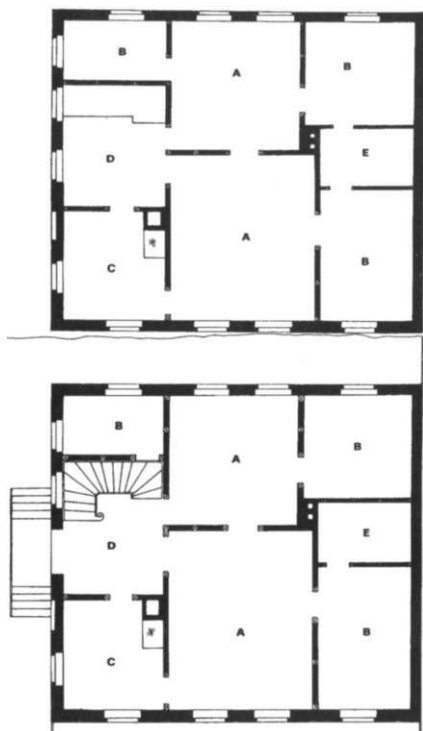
1858, Wohnhaus Olvenstedter Straße 48, Grundriß des Erdgeschosses und der Dachetage A Stube, B Kammer, C Küche, D Flur, E Alkoven
